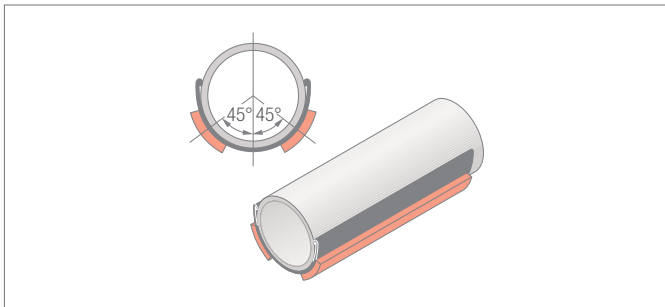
Ejemplo de instalación con calefacción auxiliar
